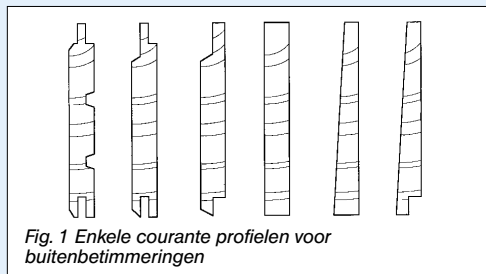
Enkele courante profielen voor buitenbetimmeringen
